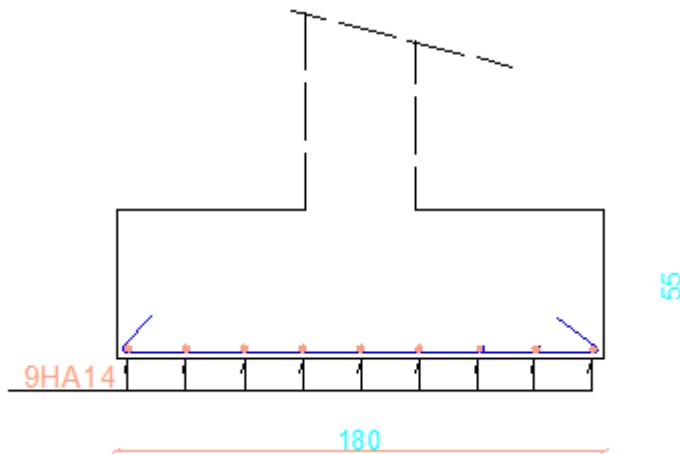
Ferrailage de la semelle intermédiaire dans le sens x-x.
